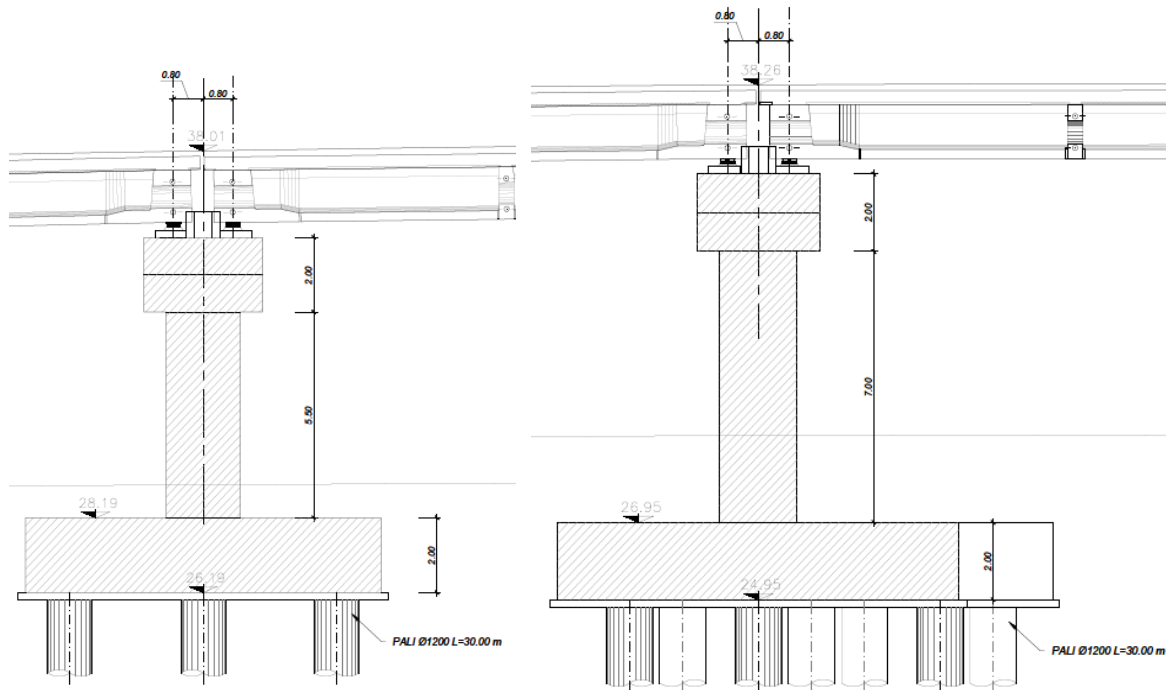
Sezione in direzione longitudinale pile 1-4 ; b) Sezione in direzione longitudinale pile 2-3
